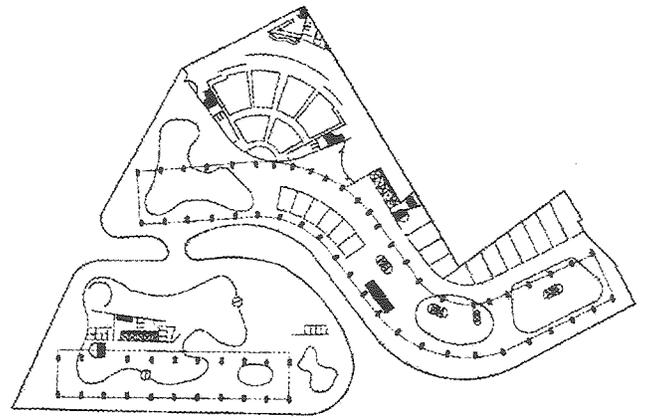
Planta do projeto original de Niemeyer para o terraço jardim da laje do Conjunto Copan.
